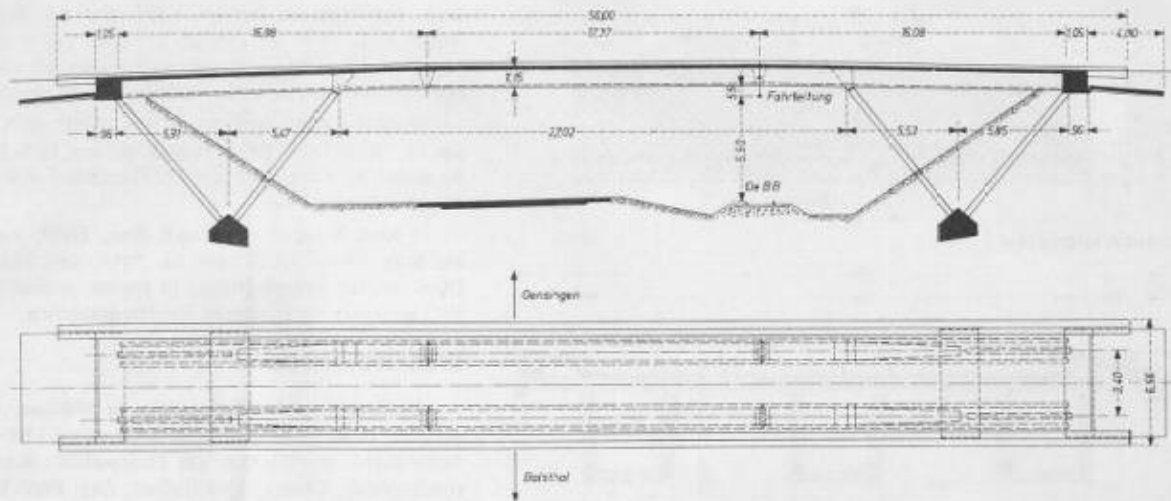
Ueberführung Oensingen, Längsschnitt und Grundriss 1:400.
